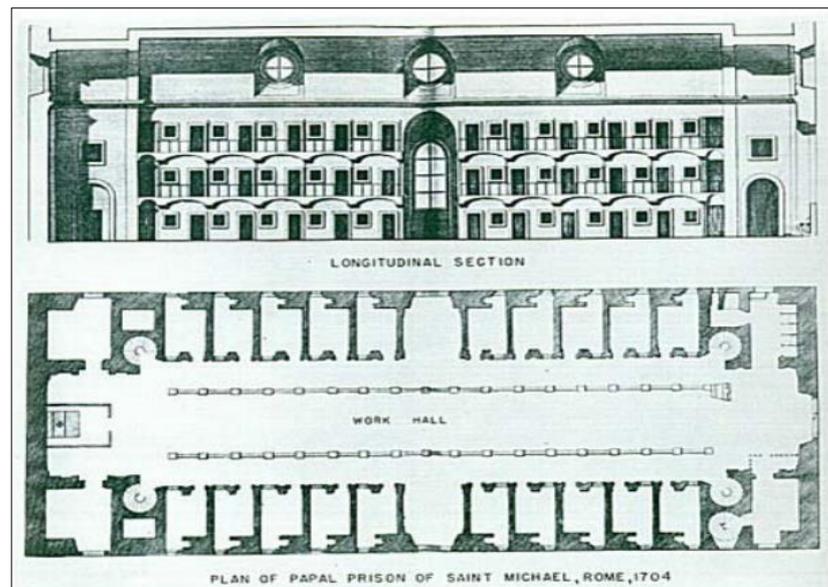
Hospital de San Michele (prisão). Corte longitudinal e planta baixa
